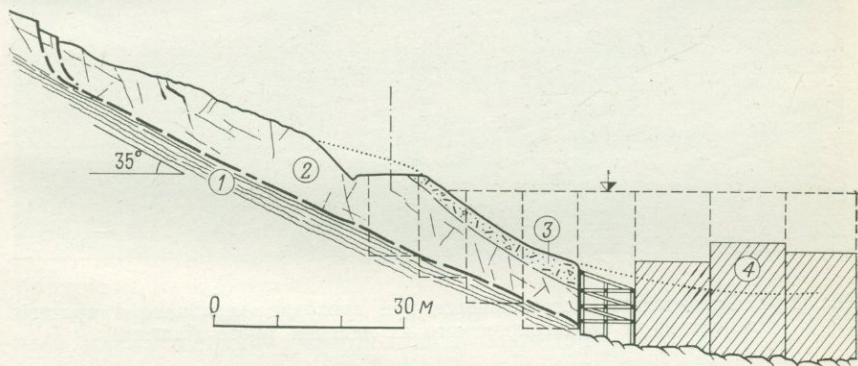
Разрез склона, устойчивость которого нарушена проходкой строительного котлована.
